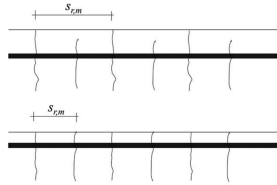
Konseptuell illustrasjon av strekkspenningens spredning i betongen mellom to riss [3]
